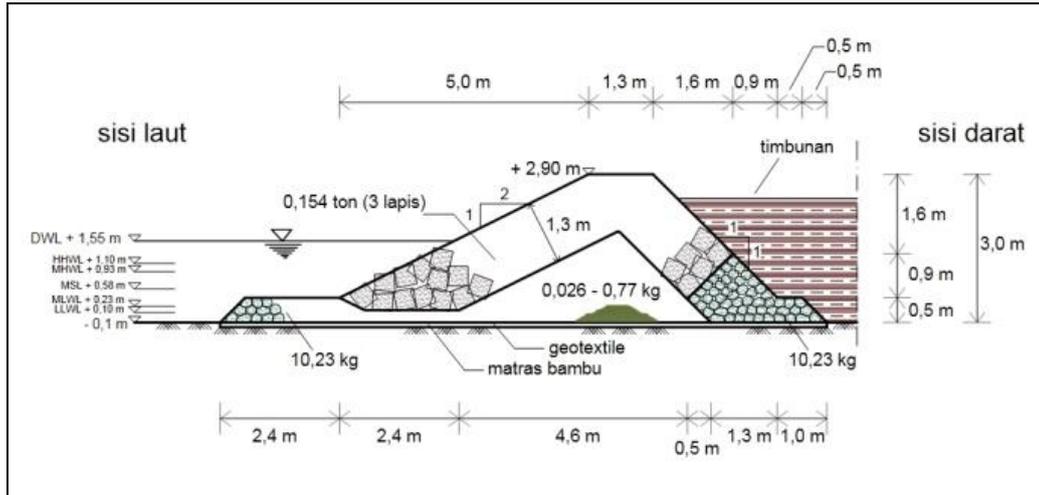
Rencana perlindungan pantai Sayung Demak
